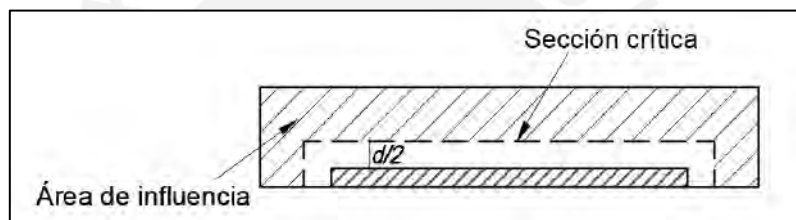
Sección crítica debido al punzonamiento en la zapata Z-07
